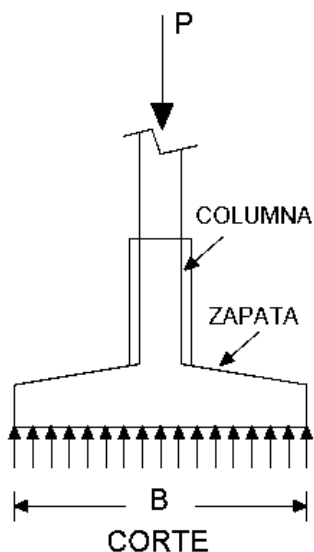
(a) Elementos que componen y actúan sobre una zapata
